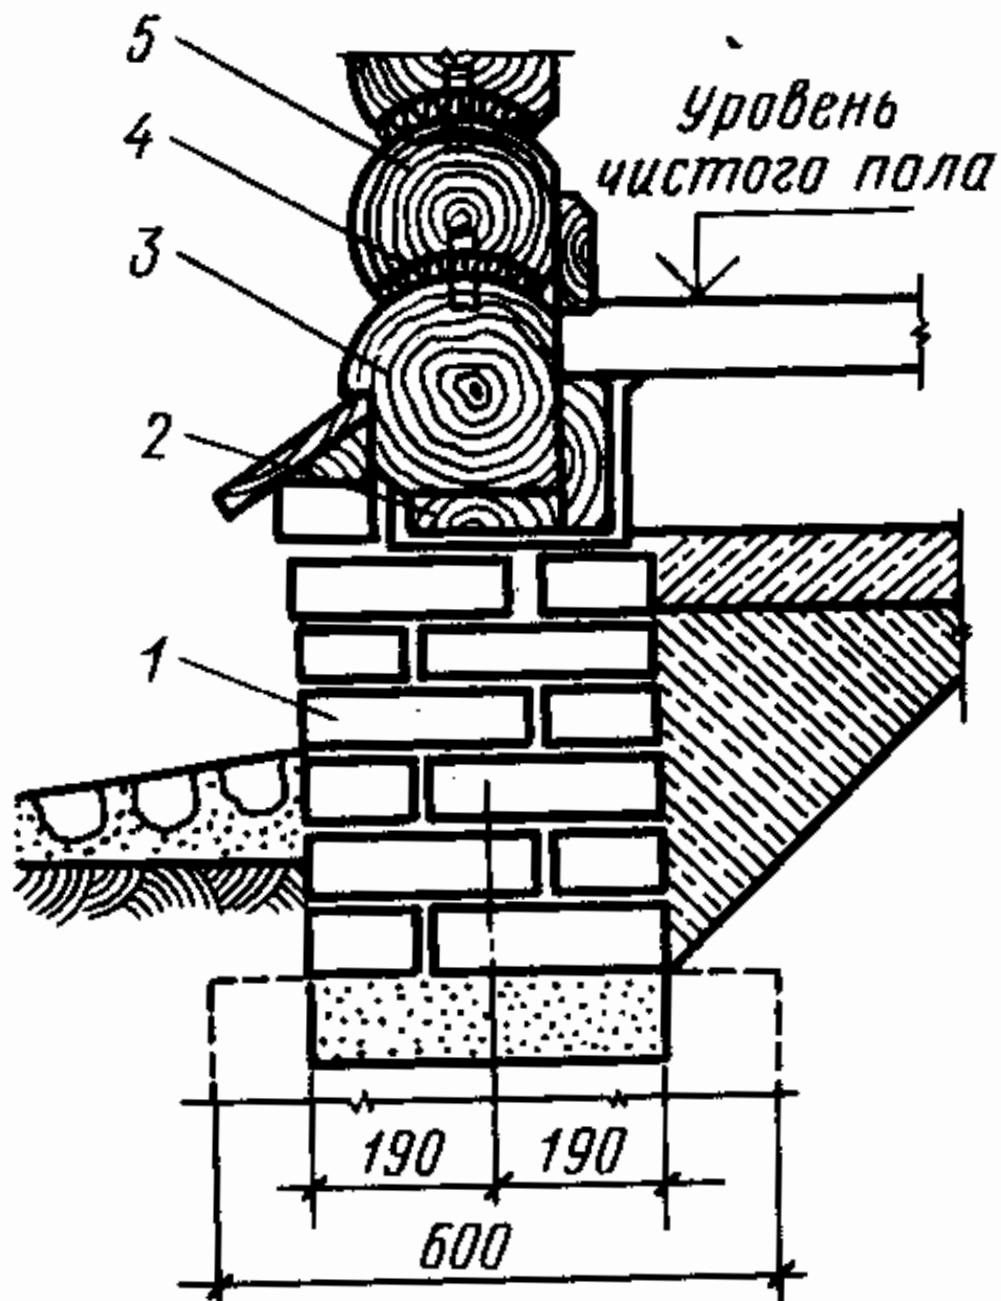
Устройство столбчатого фундамента под рубленую деревянную стену:
